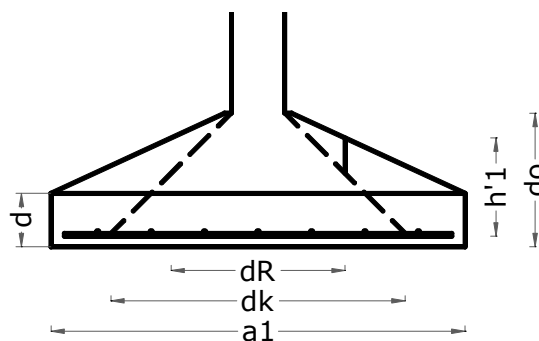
Sección considerada para el Punzonado en Bases de Galerías Perimetrales
